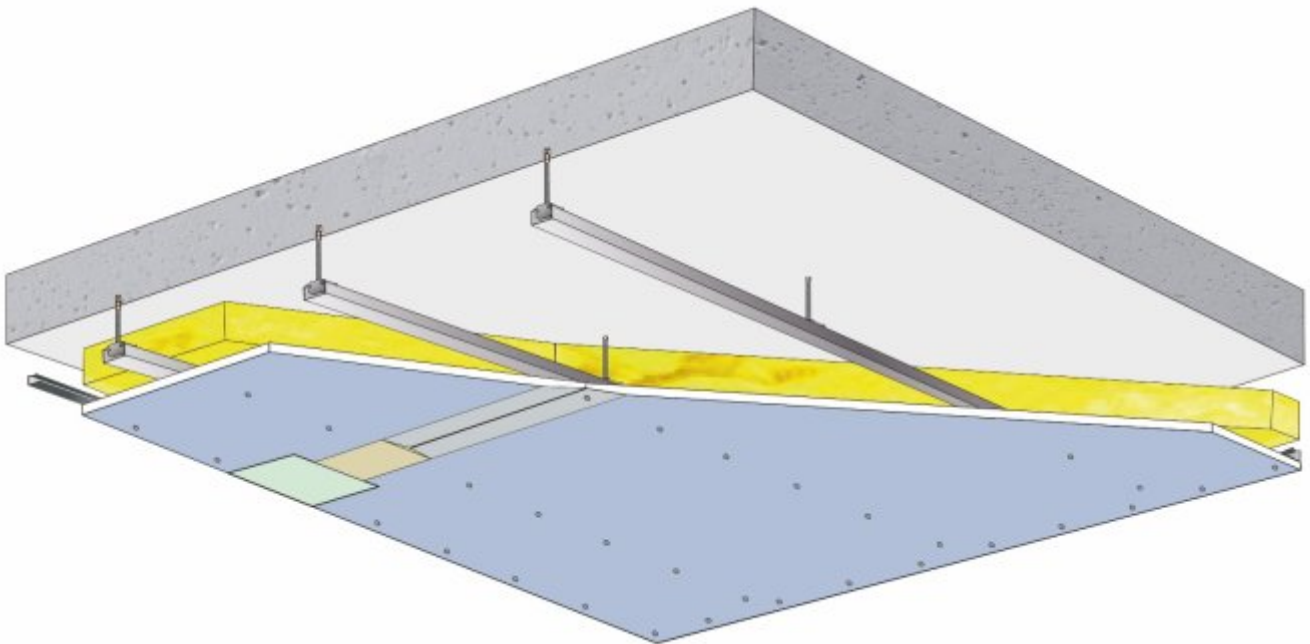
Plafond Glasroc®H Ocean sur fourrures
